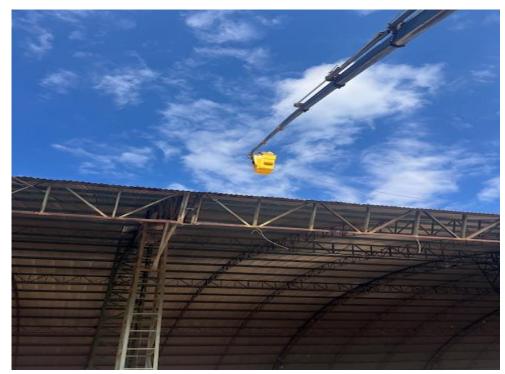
Detalhe para içamento de colaborador para substituição das telhas metálicas danificadas
